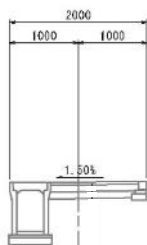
(11) 標準断面図 (特殊道路 幅員 2.0m)
